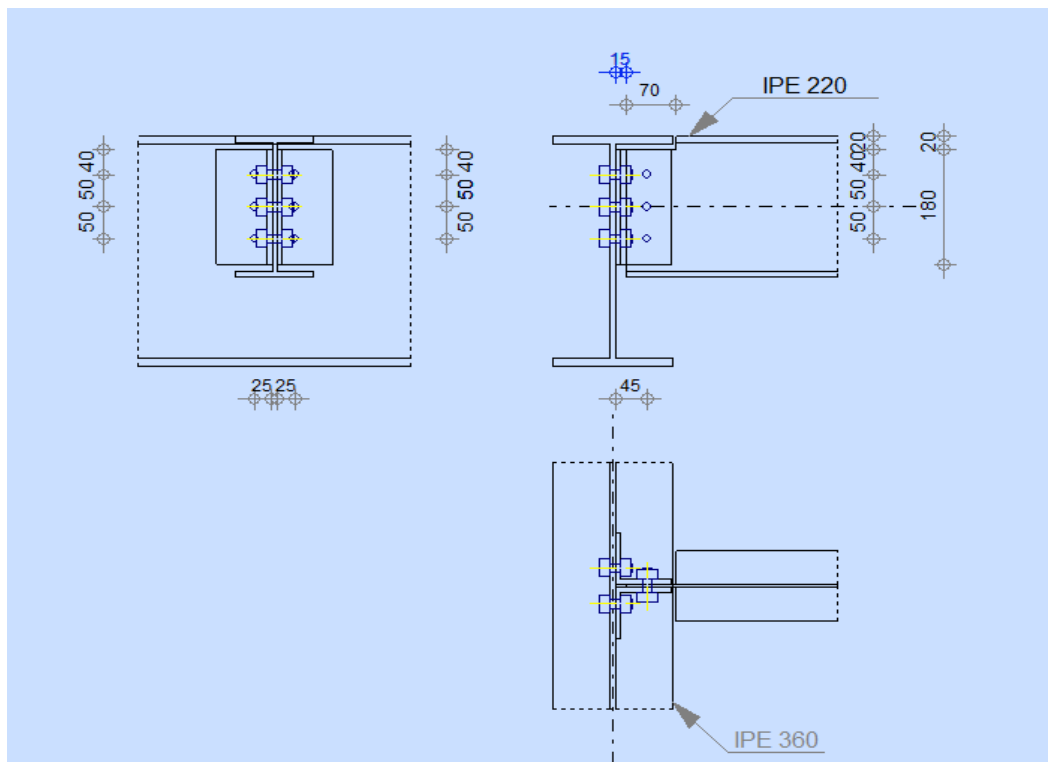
Disposition constructif de l'assemblage poutre – solive.
